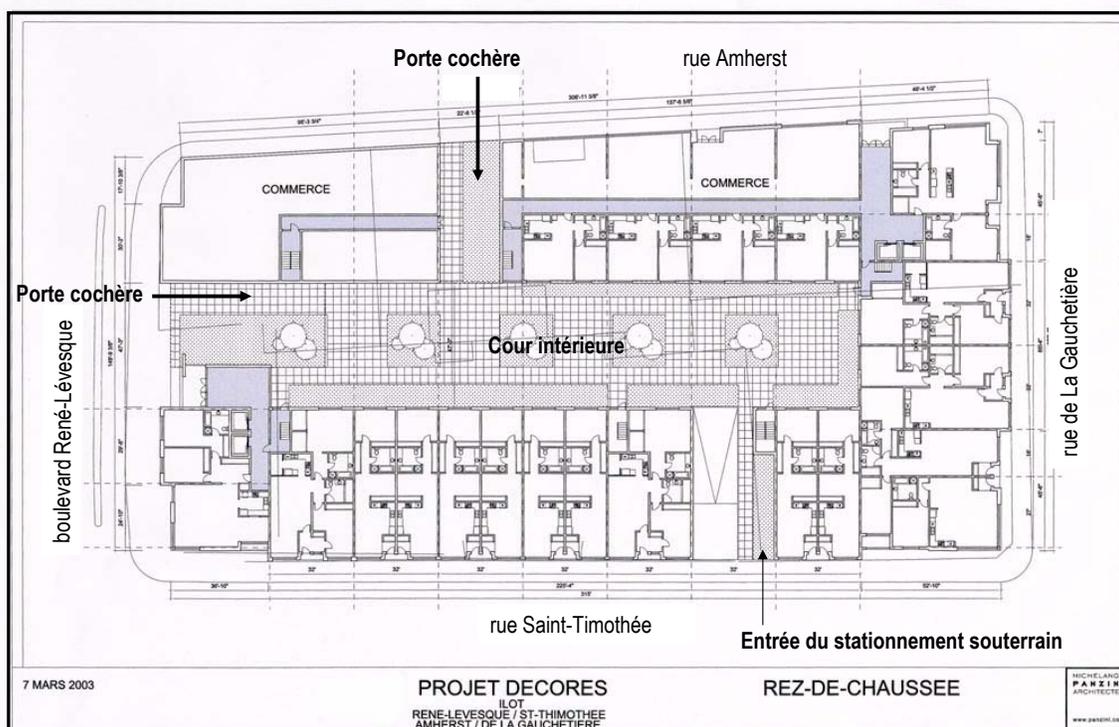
Plan du rez-de-chaussée du complexe immobilier proposé (adapté du document déposé no 2, diapositive no 35).
